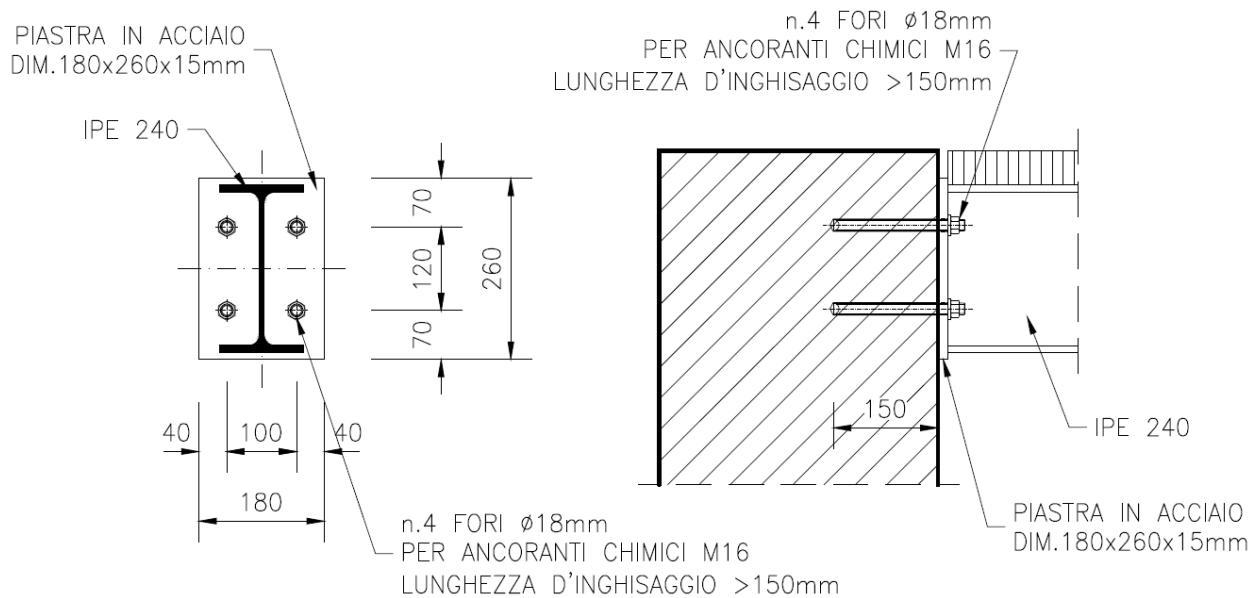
Vista frontale e sezione della connessione IPE240 - "Particolare 2"
